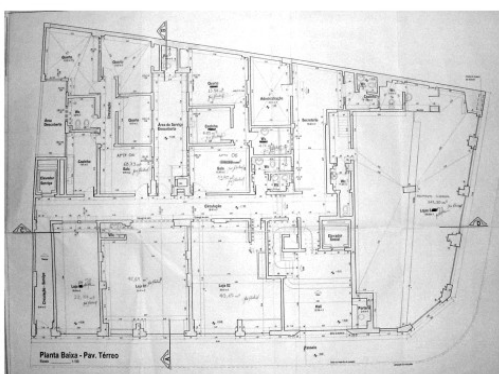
Edifício Ouro. 1950. Planta Baixa – Térreo e 6 Pavimemnto. Fonte: Prefeitura da Cidade do Recife. Foto: Marcio Erlich
